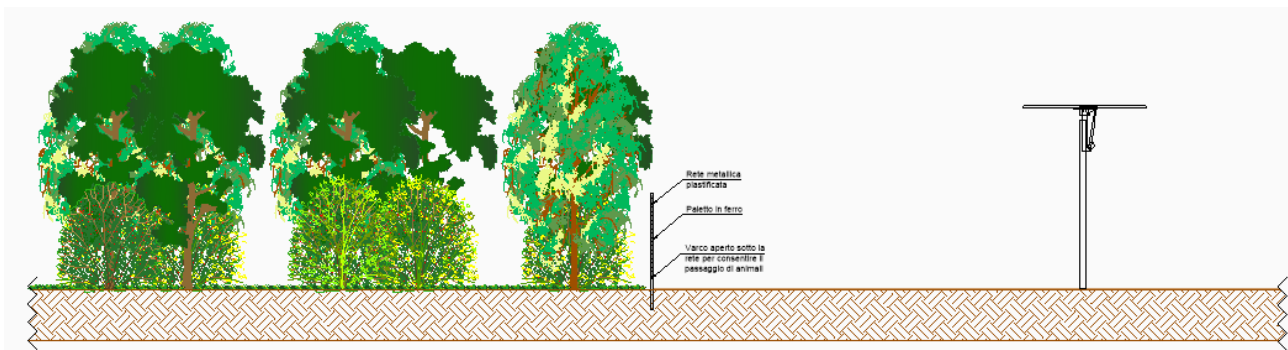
dettaglio mitigazione tipo di progetto - Prospetto laterale
